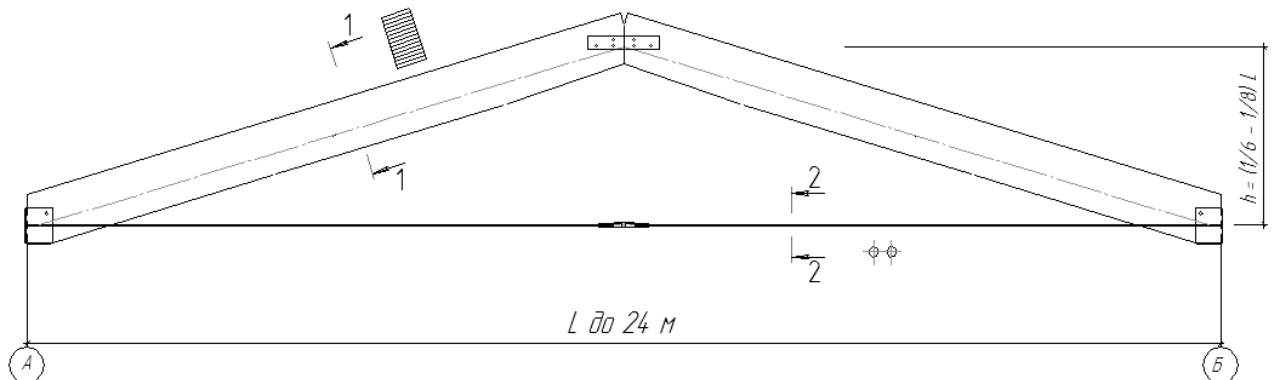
Конструктивная схема треугольной безраскосной фермы
